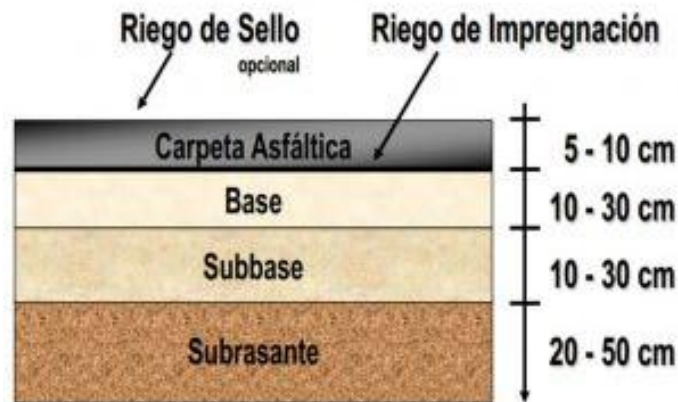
Sección transversal pavimento flexible. Fuente: Tomada de <http://website.mott.pe/72569443/tag/asfalto-caliente>
